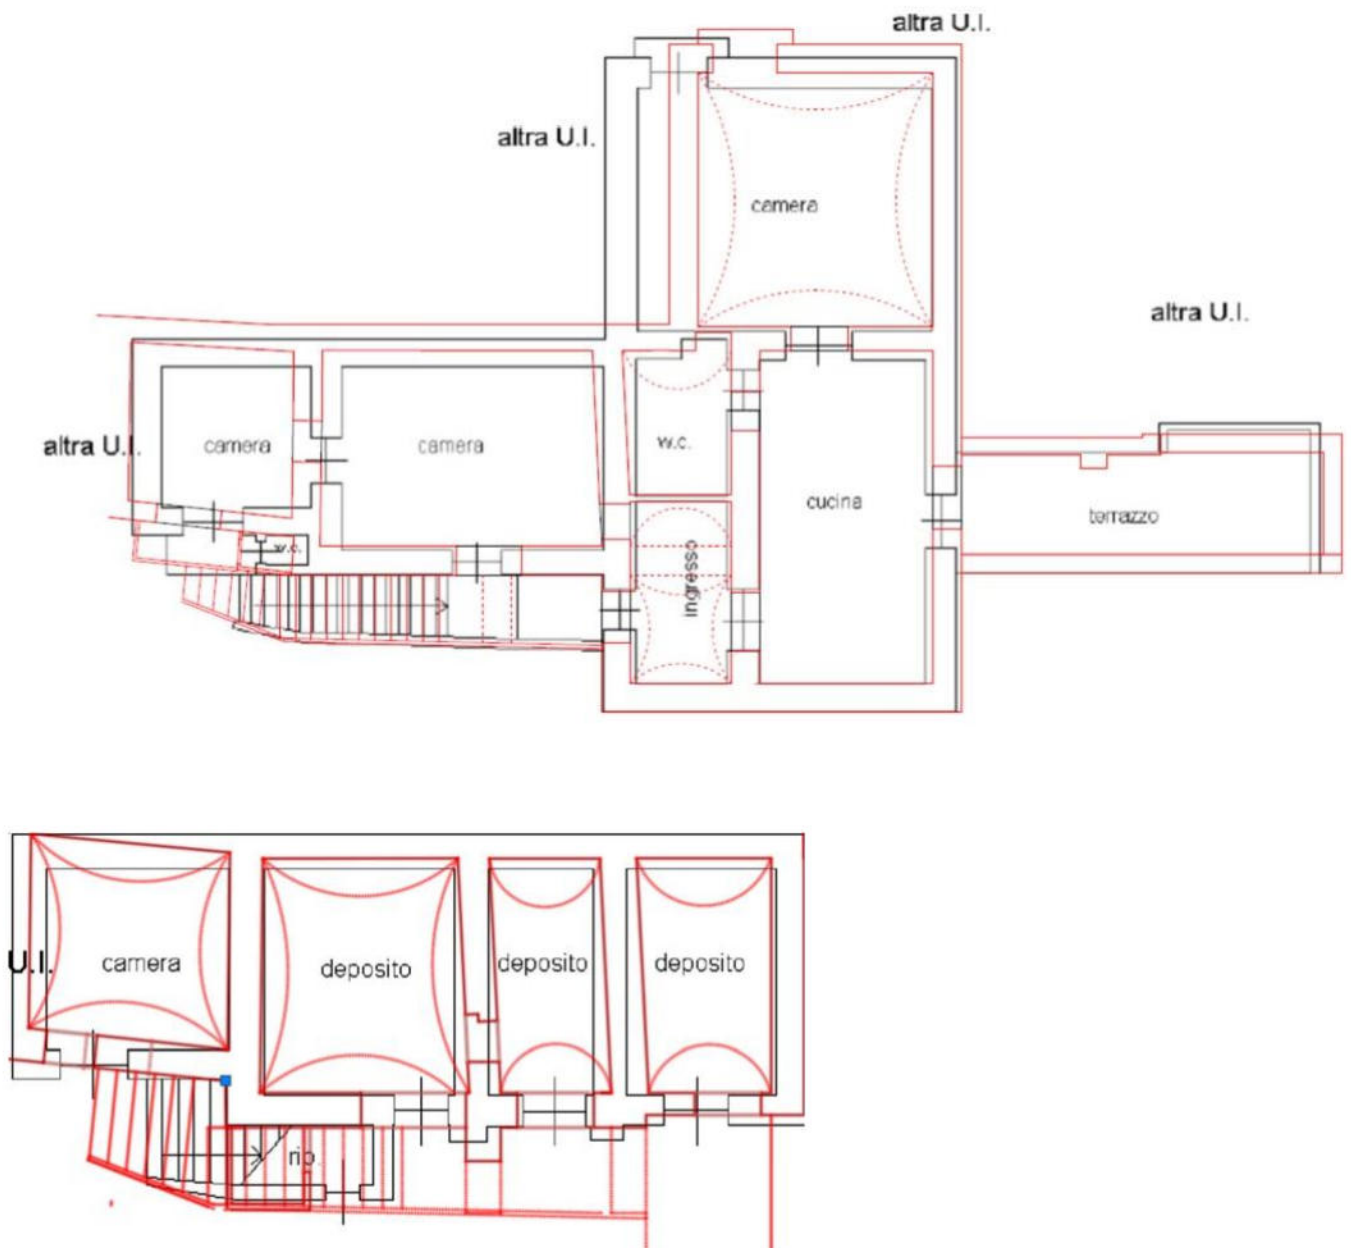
Figura 5: Sovrapposizione planimetria catastale(nero) e rilievo (rosso)
